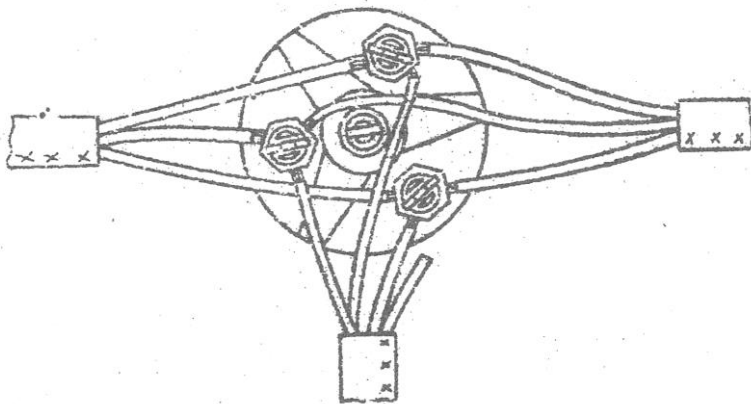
Подсоединение жил кабелей в корпусе муфты тройниковой МТ-1
